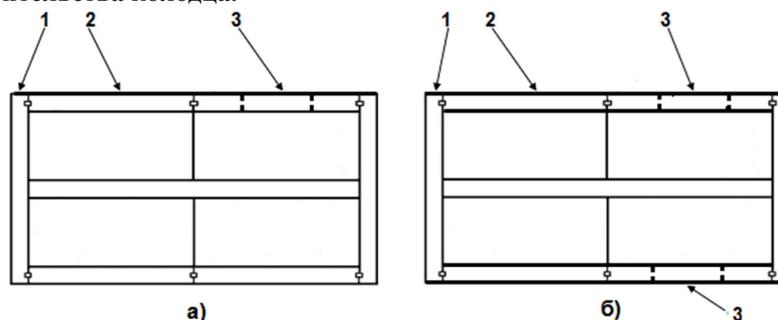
Виды сверху на колодцы без плит покрытия:
